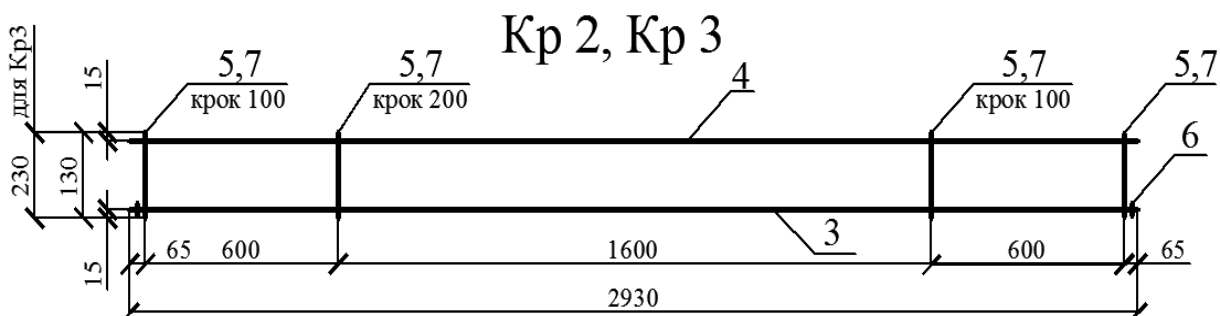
Плоскі арматурні каркаси поперечних ребер та відомість стрижнів для них.
